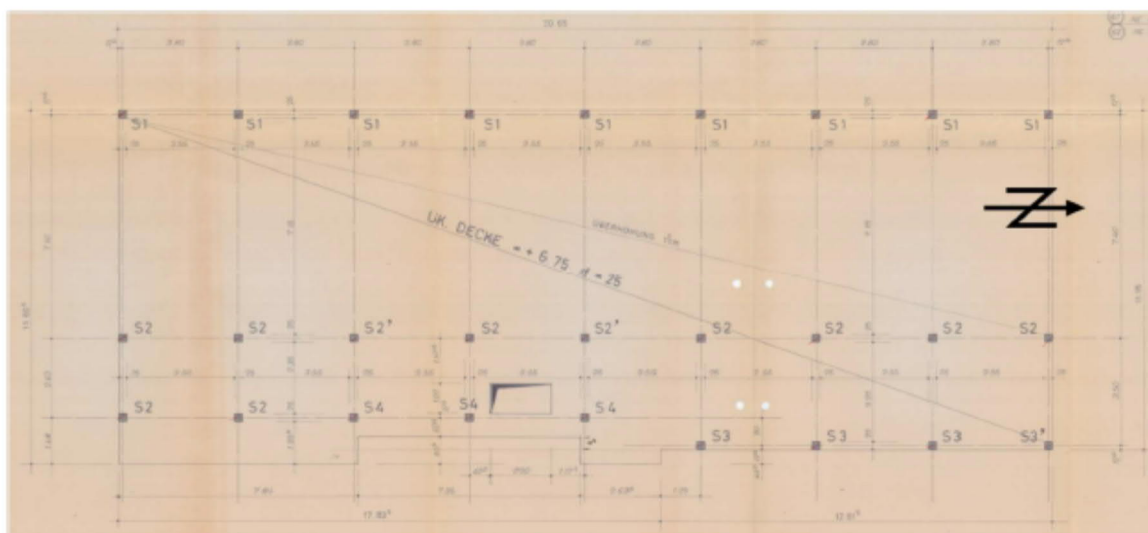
Plan horizontal de la partie 2 du bâtiment, étage supérieur du bâtiment scolaire.
